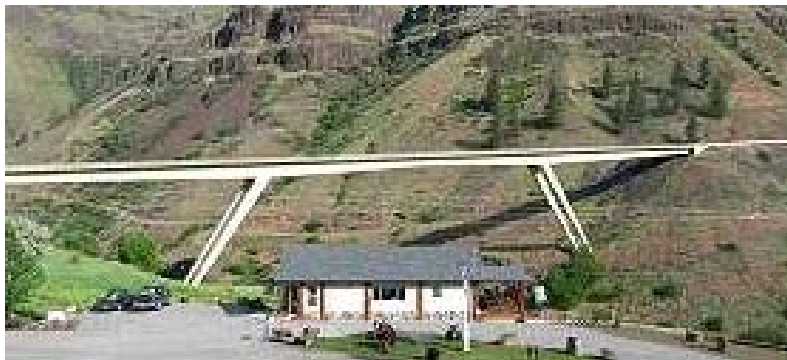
Foto del puente White bird Canyon, Idaho, EUA
